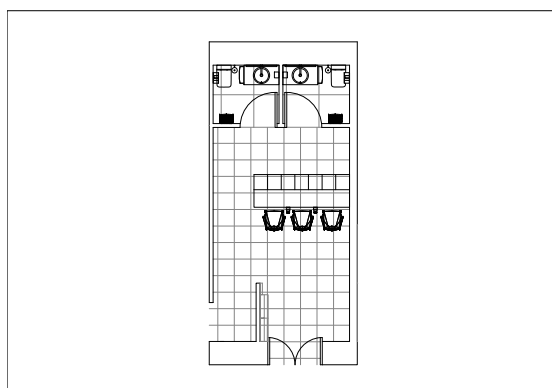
Planta de proposta aproximada da zona de bastidores. Elaborado por: Vera Sancho
